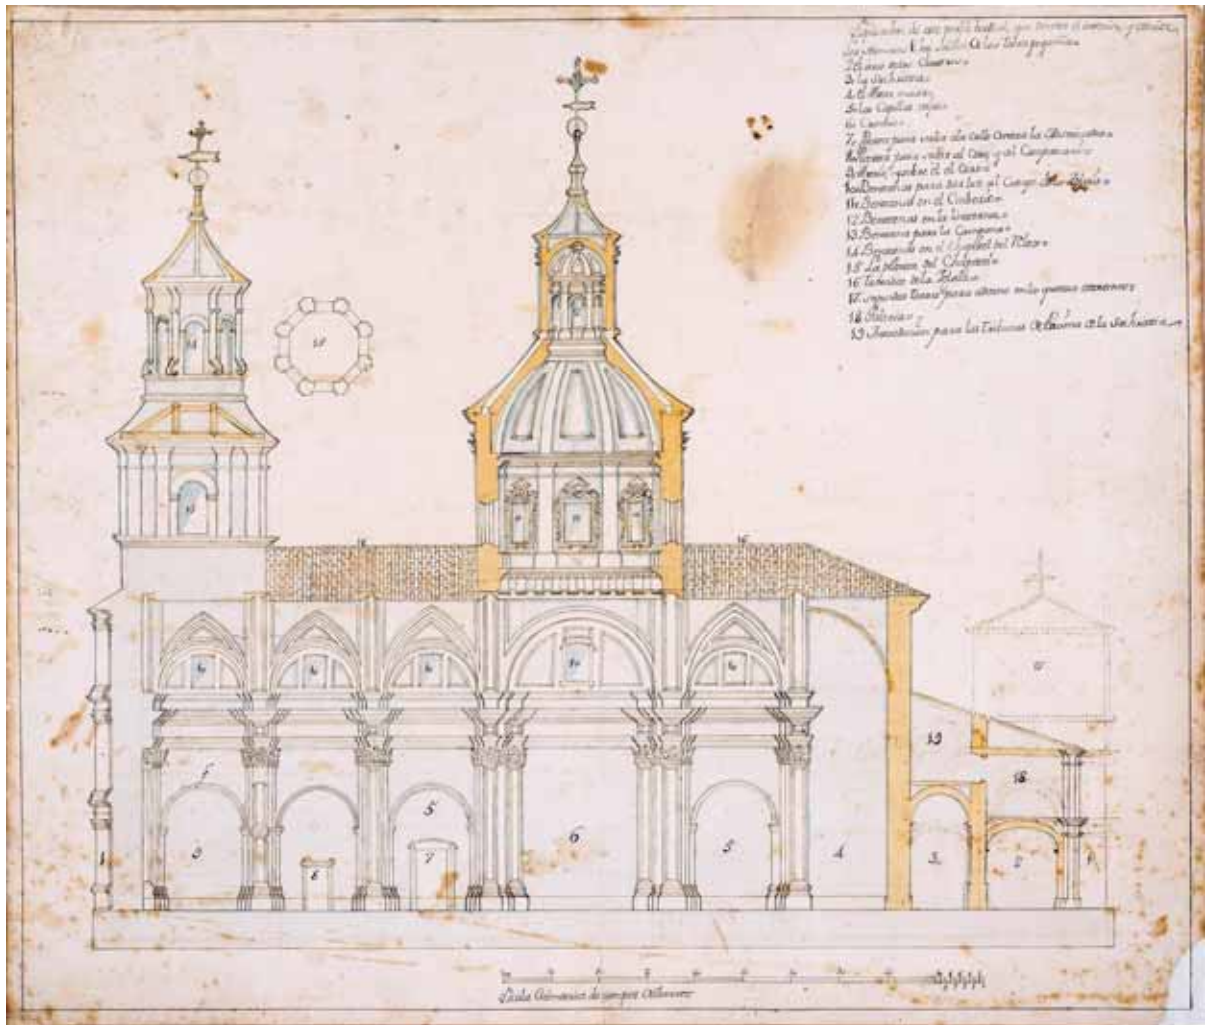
Sección vertical correspondiente a la planta anterior. 1759 (AMP)
